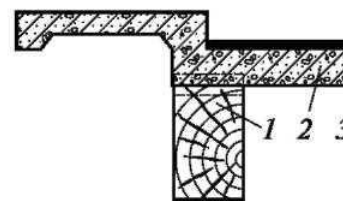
Конструкція деревозалізобетонної балочної пролітної будови:
